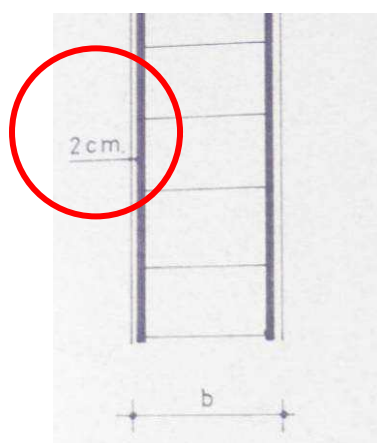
Detalle de pilar. Edificio ficha 212C.009, 1972
